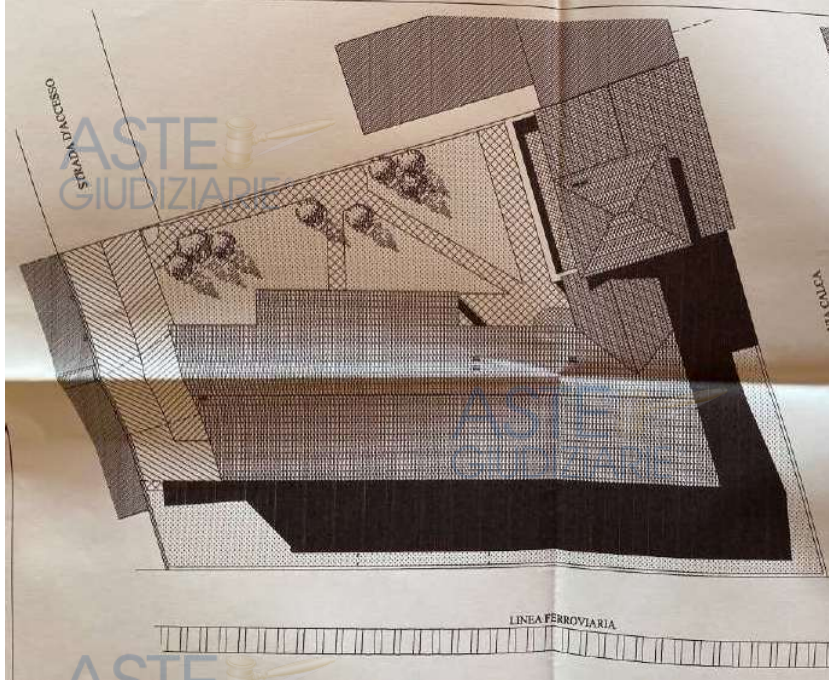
D.I.A. n. 411 prot. 37248 del 09.12.2005 – Estratto tav. 1 planimetria generale
